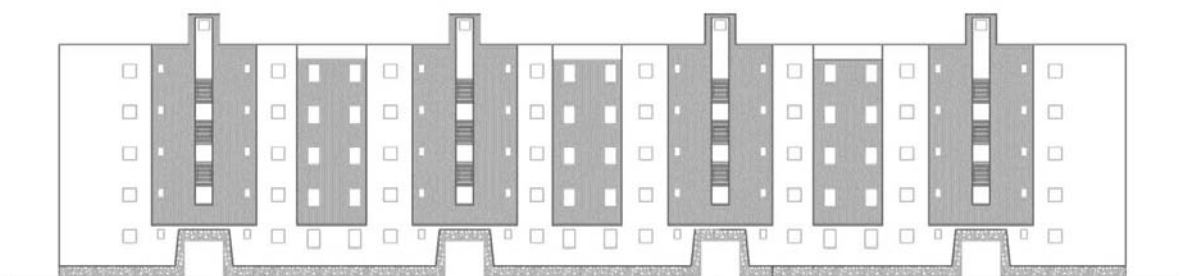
Fachada principal. Norte [Anexo II. Planos]
